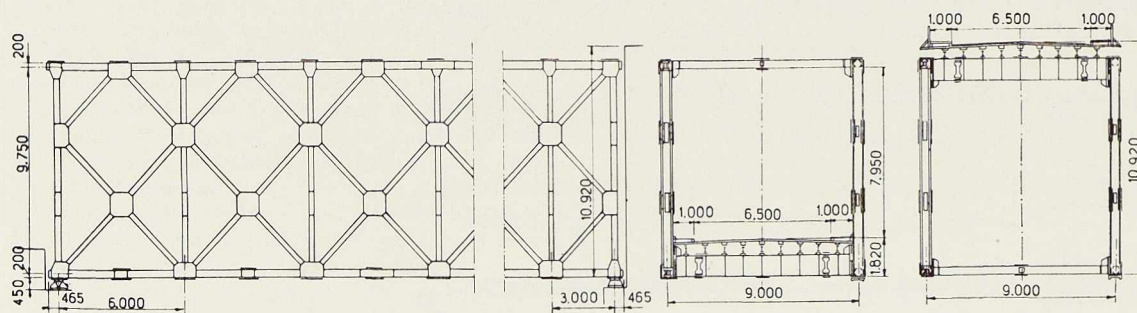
Maîtresse-poutre à triple hauteur du type R₁, utilisée pour la reconstruction du pont-route à Tulln.
